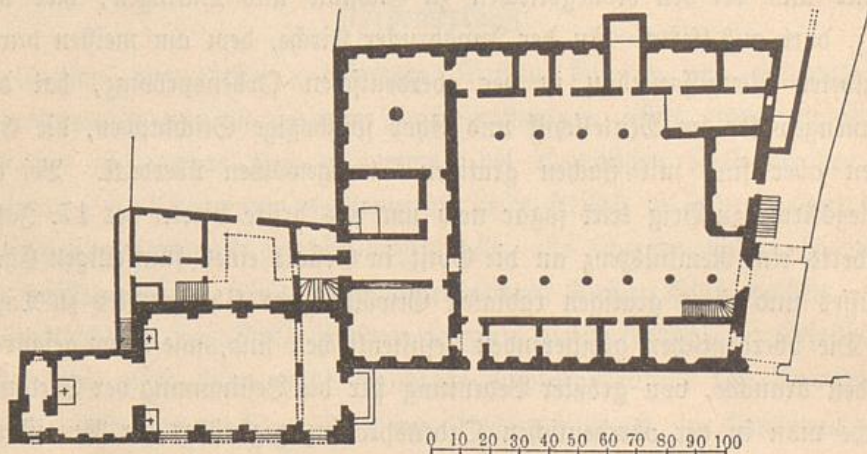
Innsbruck. Kolleg und Kirche, Grundriß. (Nach Originalgrundriß.)
